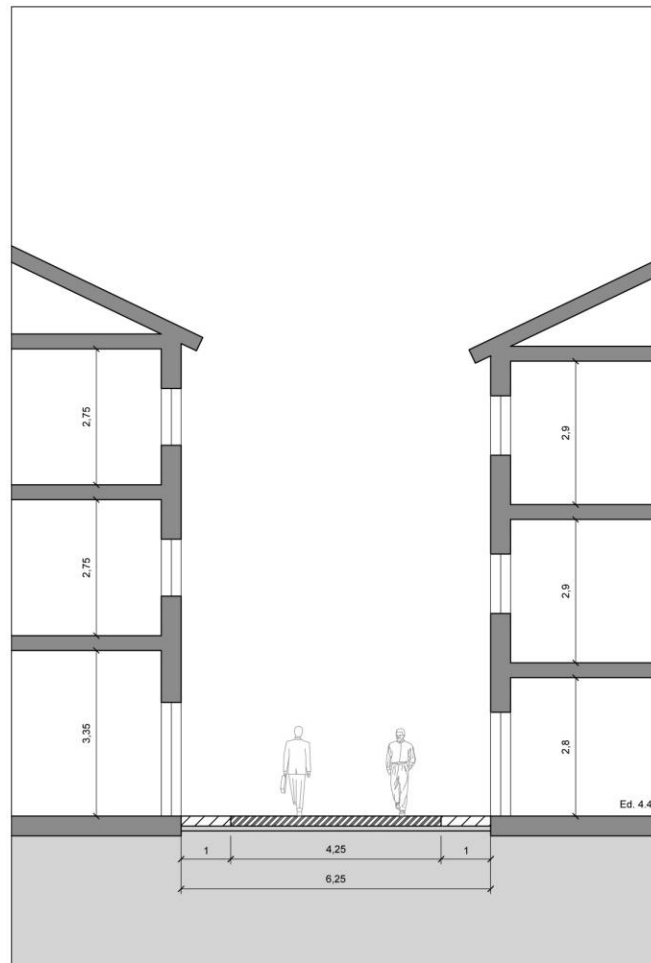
Perfil tipo de arruamento pedonal existente (Rua Direita) (anexo a.13)
